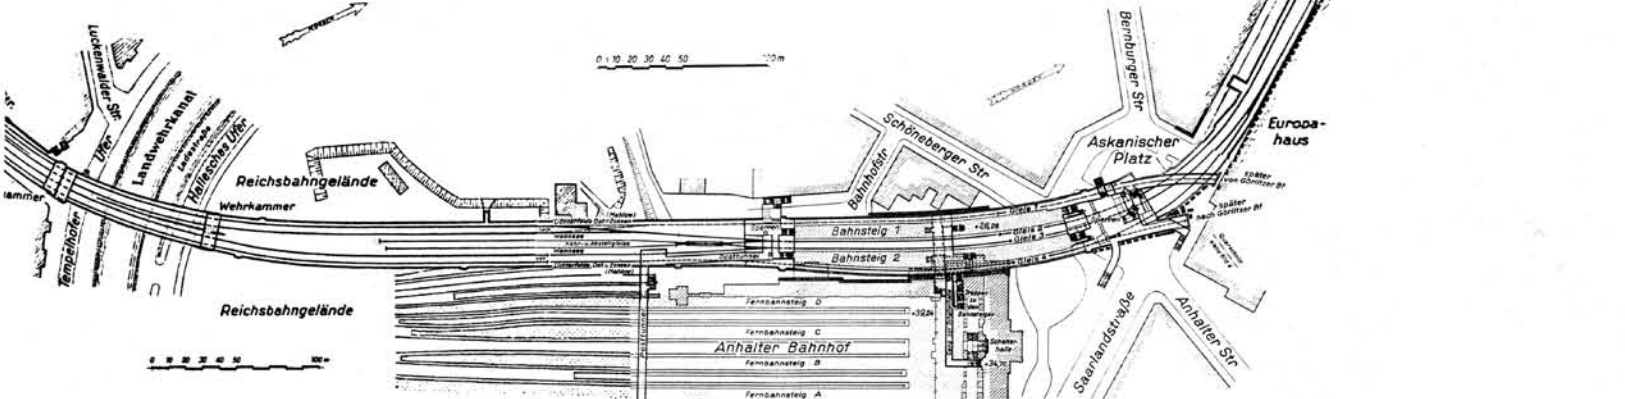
Plan der Baugrube des Anhalters Fernbahnhofs. M. 1:400.
